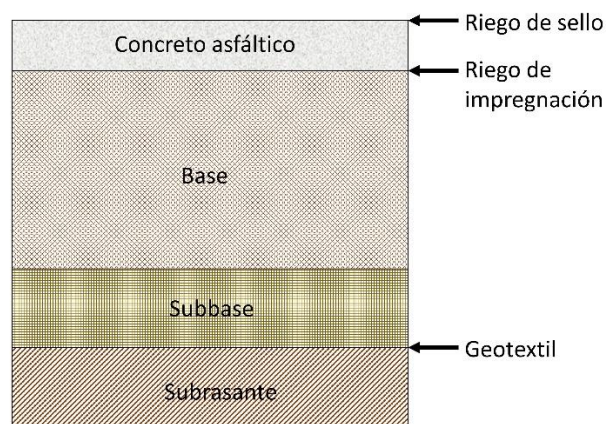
Sección transversal típica de un pavimento flexible (AASHTO, 1993)
